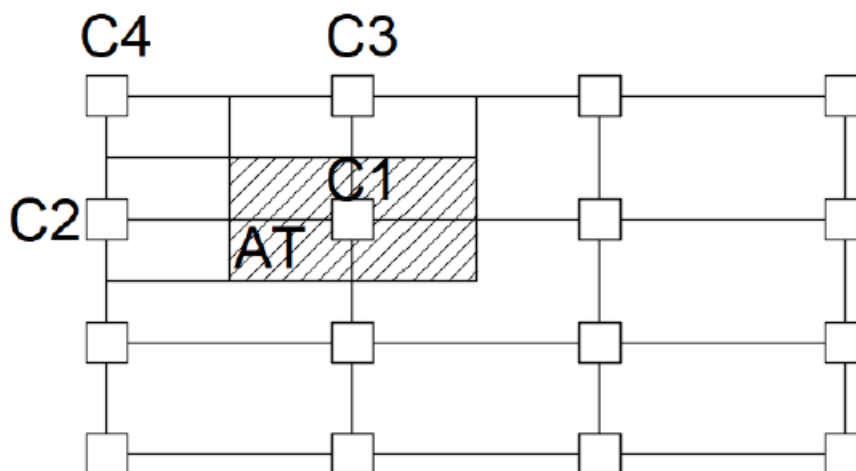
Clasificación del tipo de columnas para el predimensionamiento de sistema aporticado.
